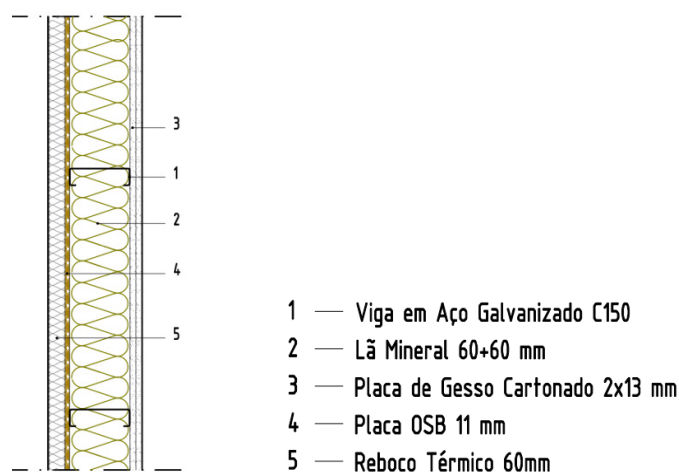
Pormenor tipo de parede exterior em estrutura leve em aço [15].
